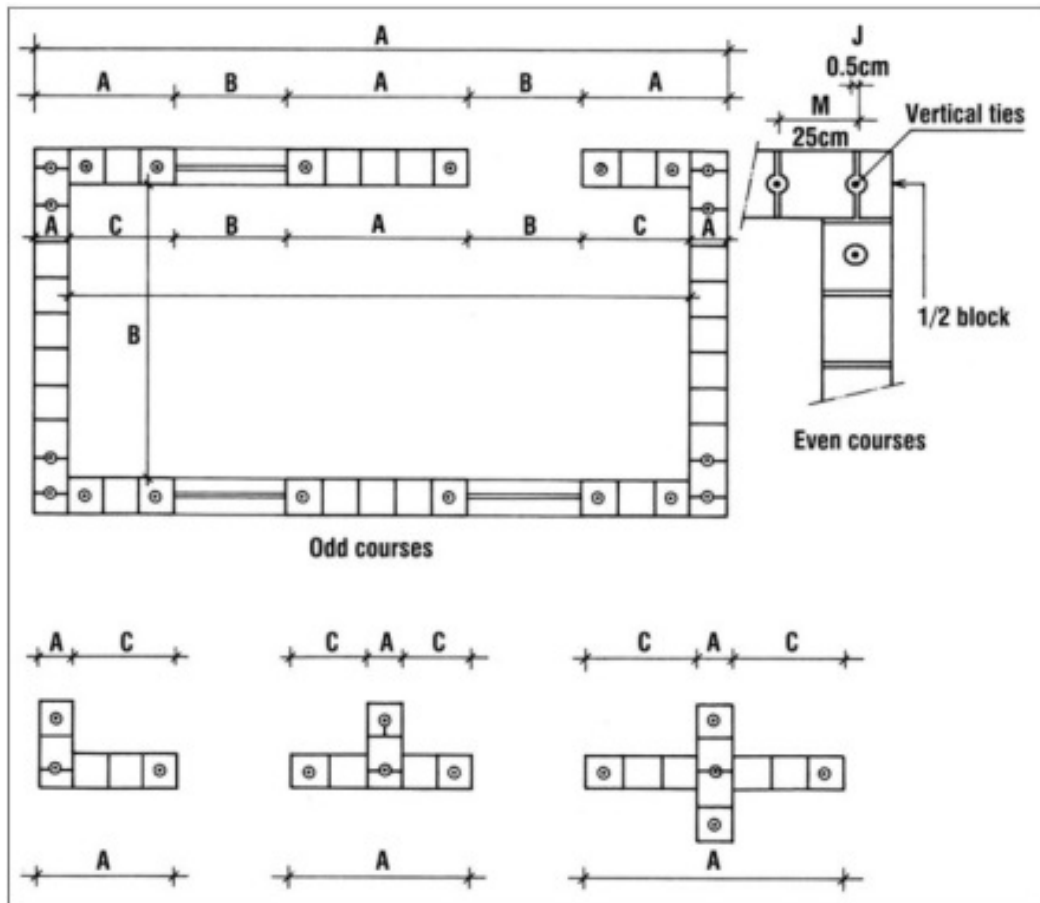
Despiece en planta de los bloques tipo 295 de Auroville. Fuente: (Auroville Earth Institute, 2005).
